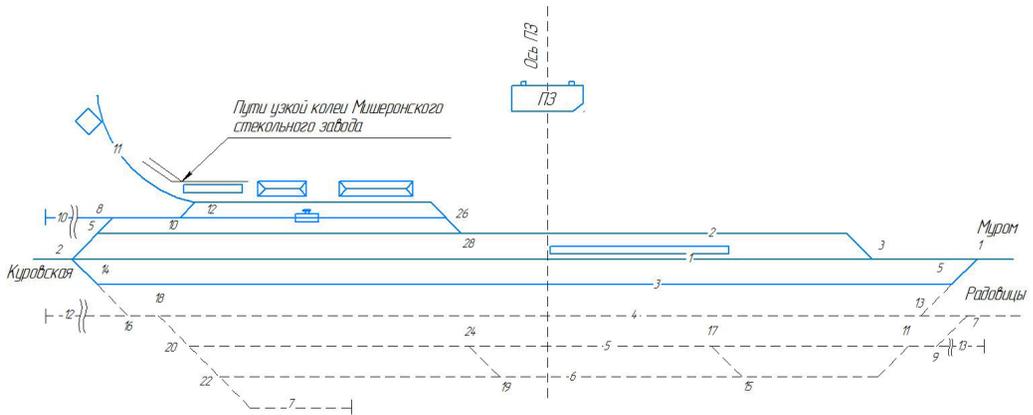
Схематический план станции Кривандино. Реконструкция на основе ГБУ «ЦГА Москвы»
